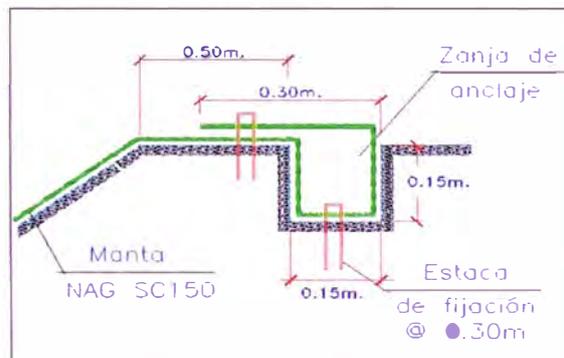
Detalle zanja de anclaje y biomanta NAG SC-150.
